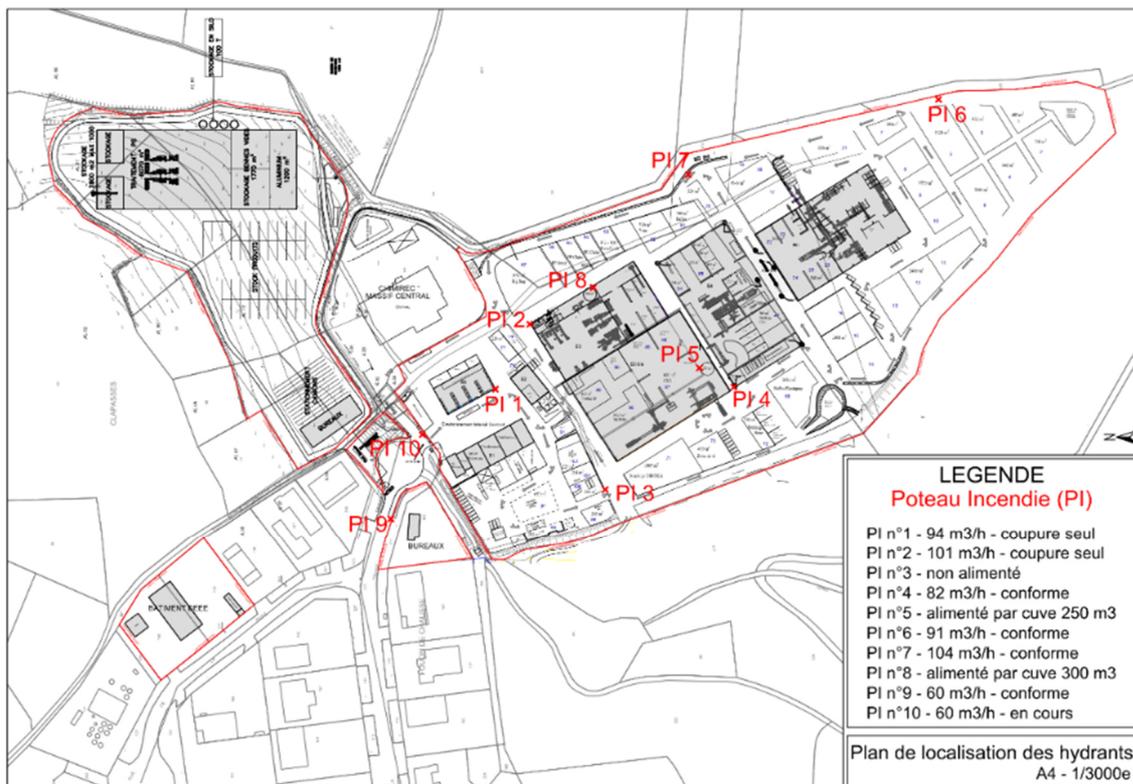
Plan de localisation des hydrants sur le site d'Environnement Massif Central
